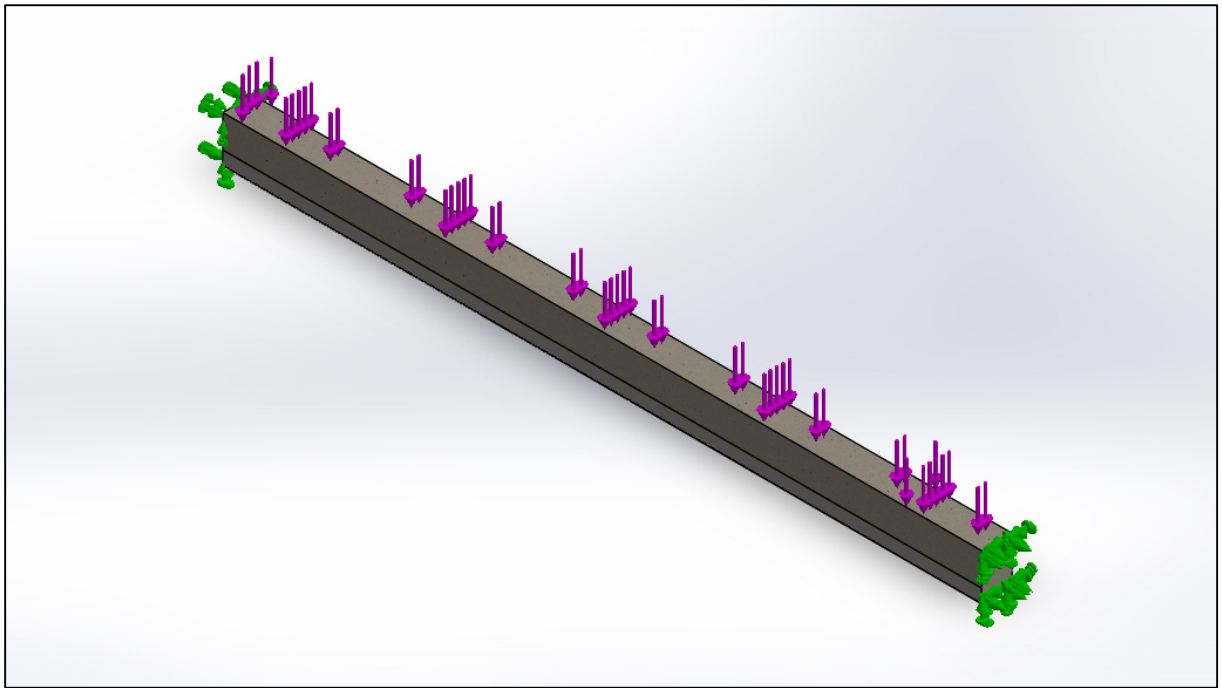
Visualização das condições de apoio e cargas para a viga de betão com a aplicação do reforço 3a.
